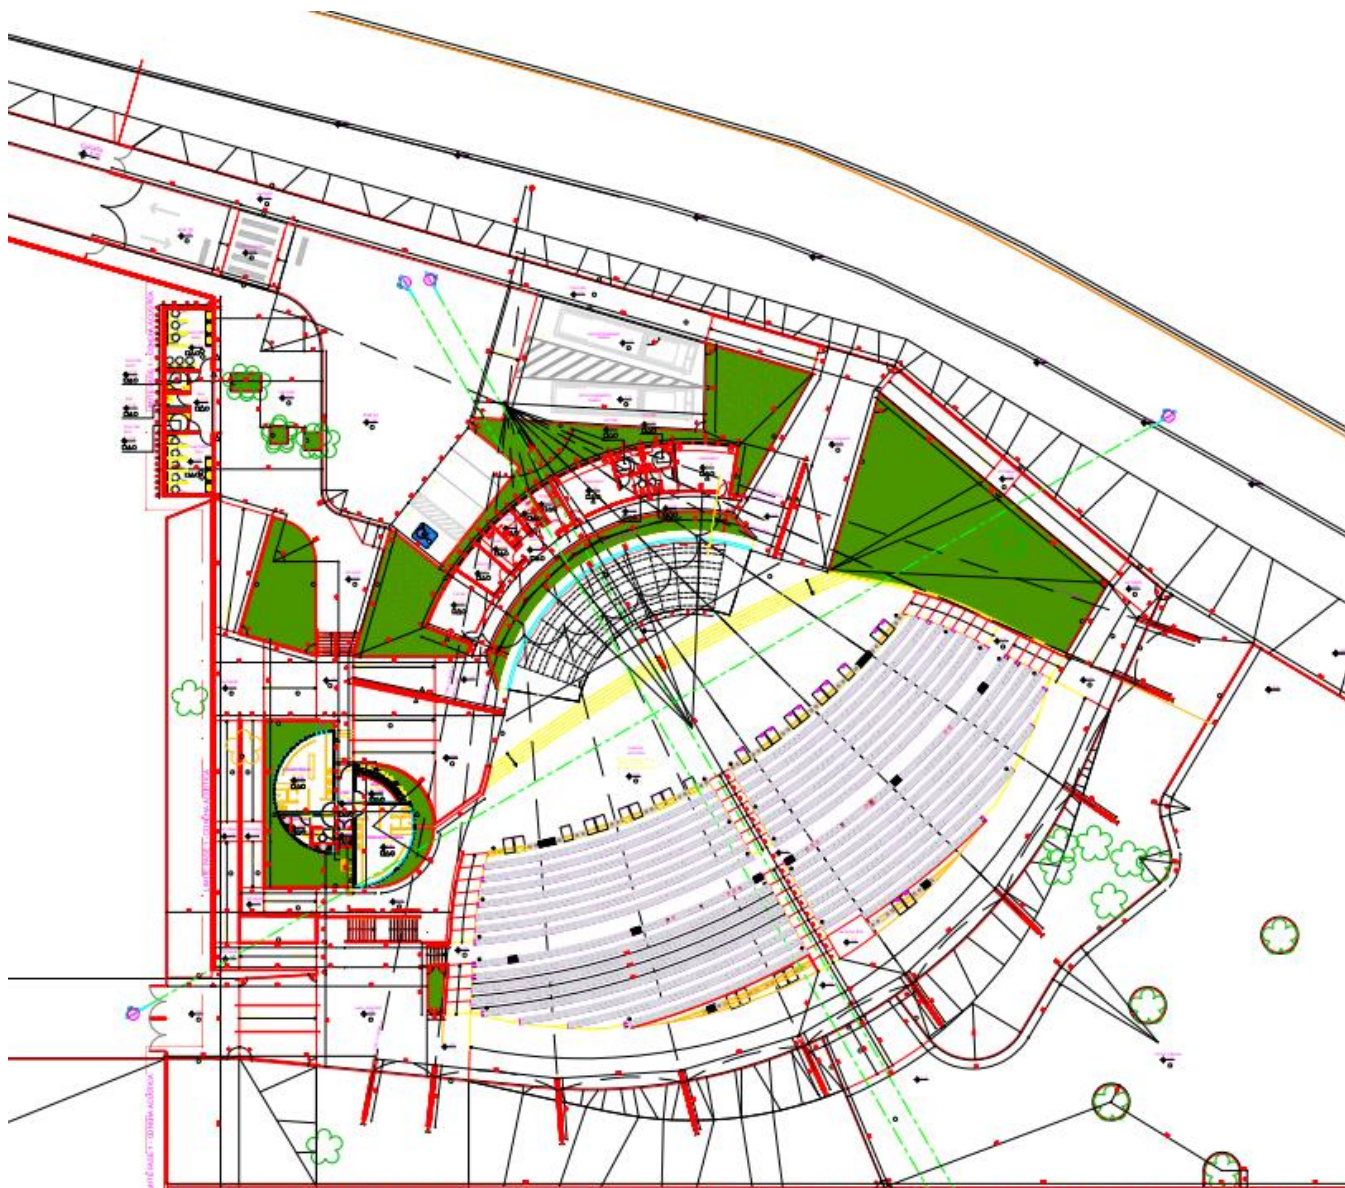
Planta baixa da Concha Acústica e edificações do entorno
